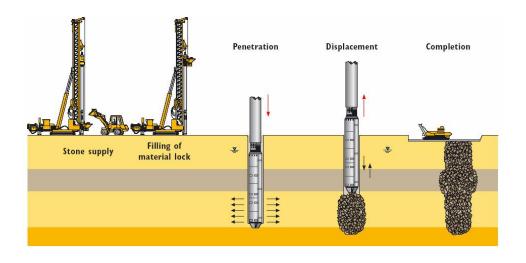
Esquema de construcción por vía seca (Raju et al., 2004, citado en Cimentada, 2009).
